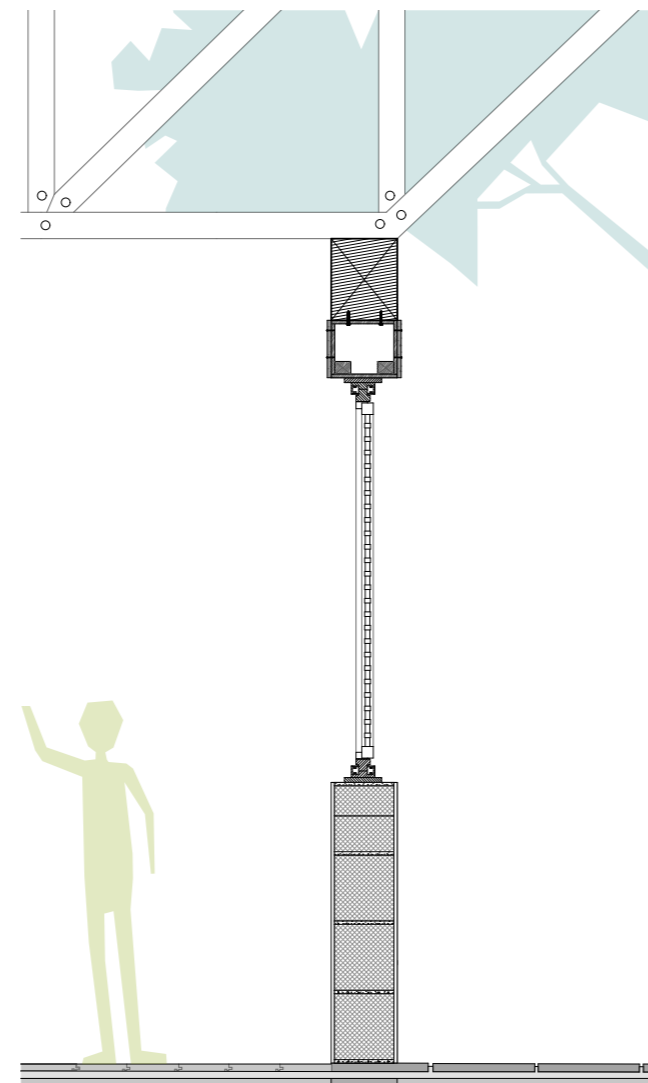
Sección constructiva bloque inicial. Fuente: Elaboración propia.
